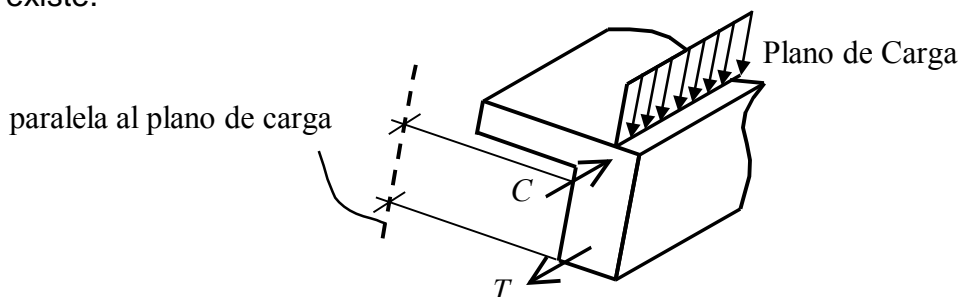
Viga aislada con sección transversal asimétrica con respecto al plano de carga.
